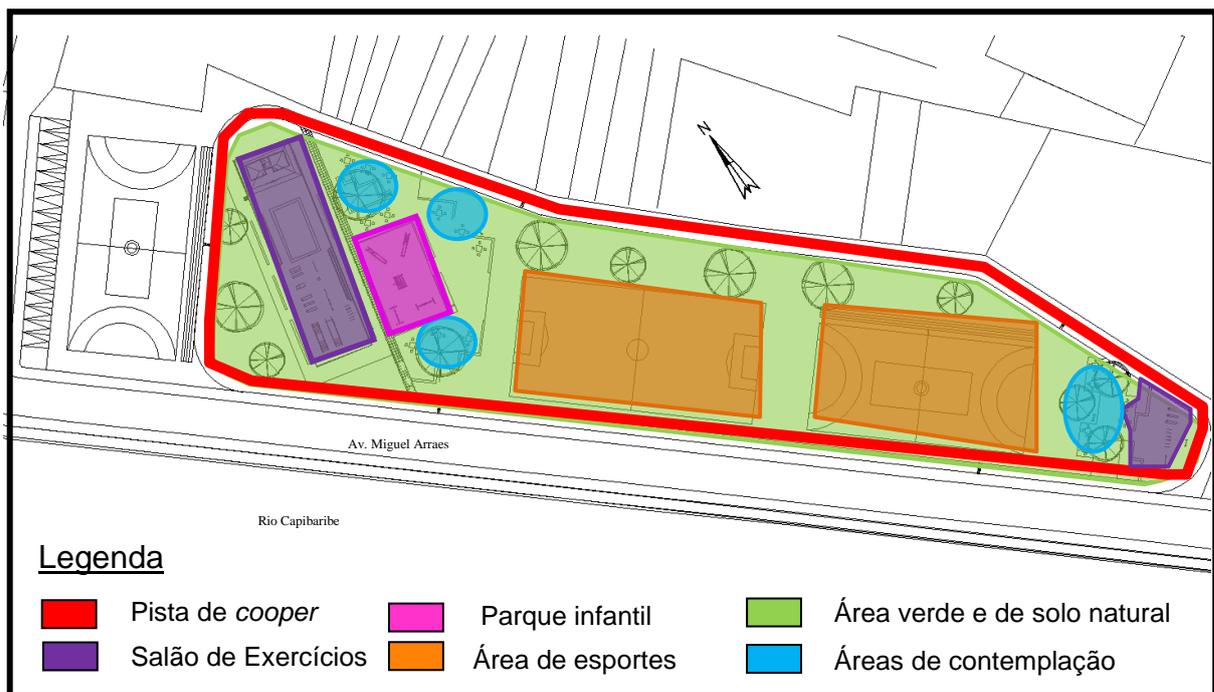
Zoneamento da Planta Baixa da Academia da Cidade de Paudalho.
